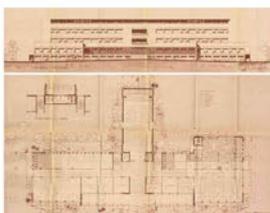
Anivado para los Hermanos Maristas, Guardamar, 1960. Miguel López González. Planta y alzado principal. (Archivo CHA).
